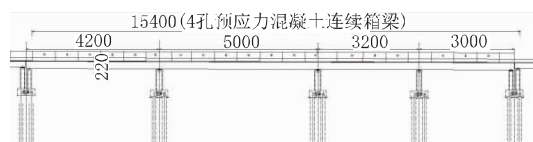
瀛海镇高架桥 A 段跨西毓顺路段立面图 (单位: cm)
